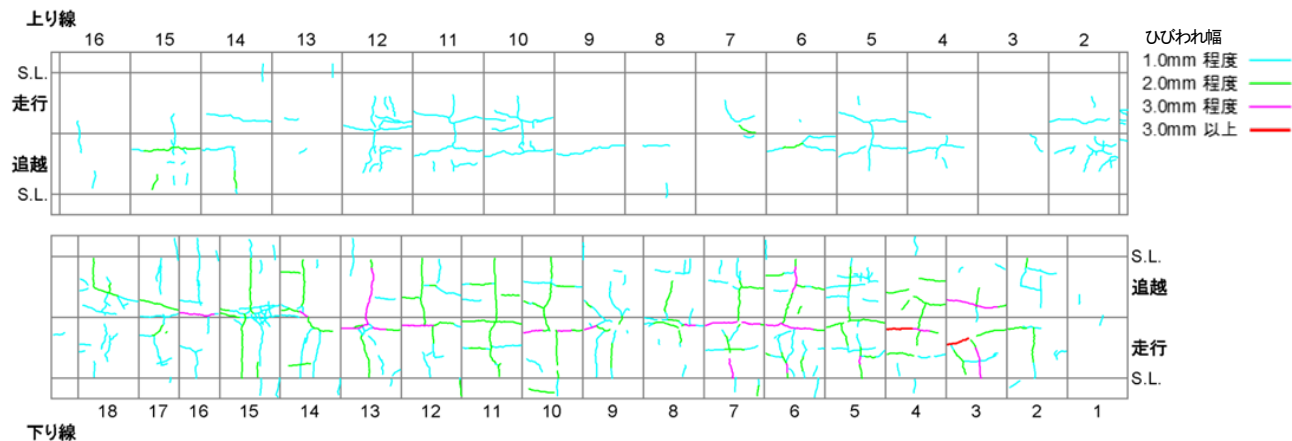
ひびわれ（ひびわれ幅1.0mm以上）展開図（数字は施工スパン名）
